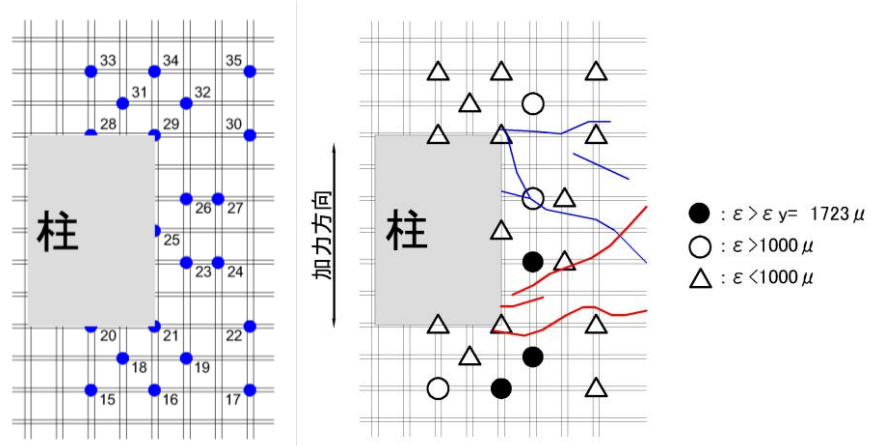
ひび割れとせん断補強筋との相対位置
